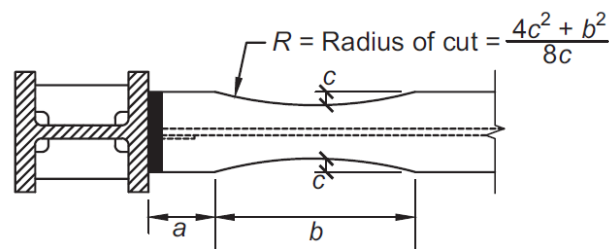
Dimensiones conexión RBS (American Institute of Steel Construction, 2016).
